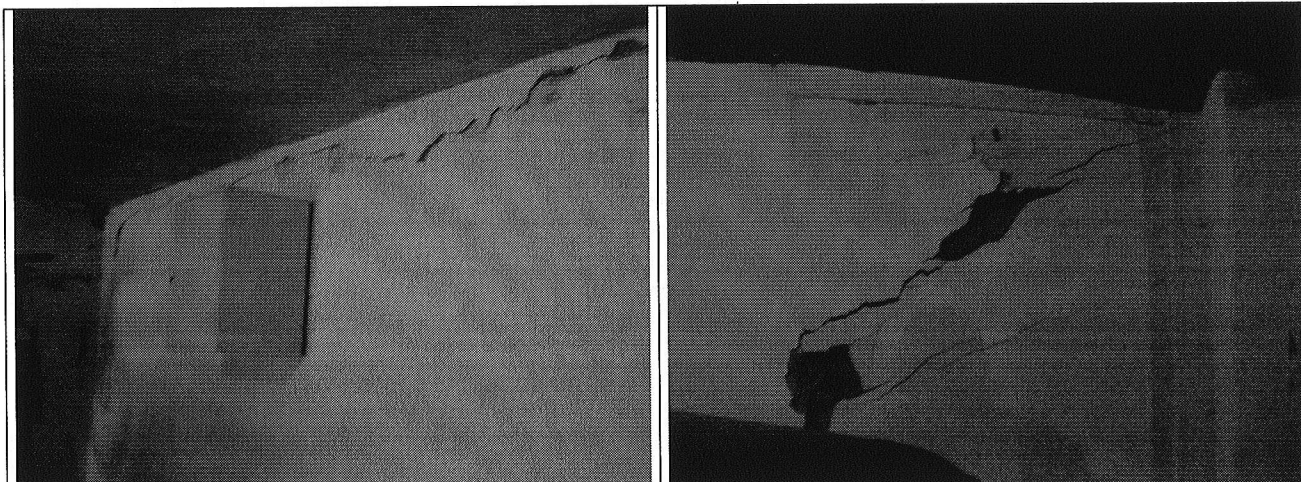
Se observan las fisuras identificadas en una viga y en una columna ubicada en el sector de acceso al nivel del sótano.
